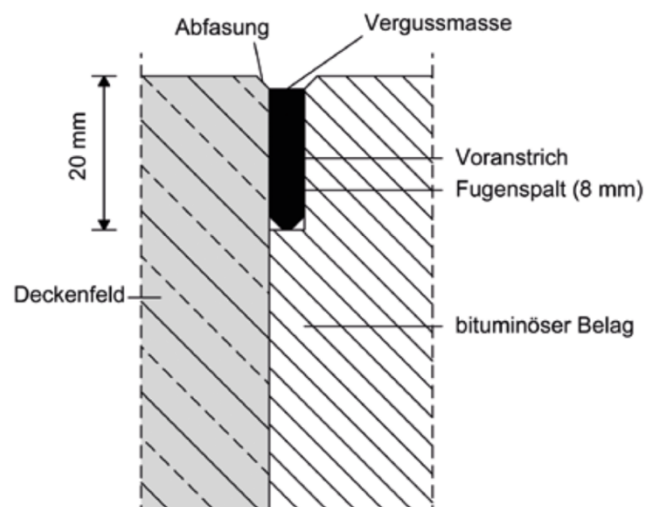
Trennfuge zwischen Randeinfassung und Betondecke [4]
